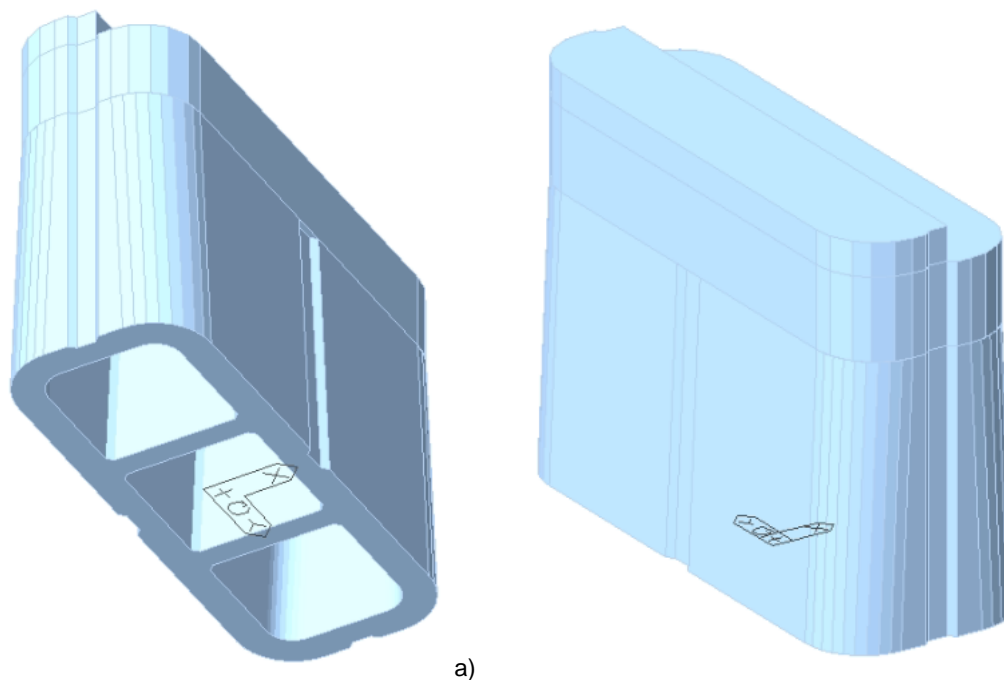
Modellazione tridimensionale agli Elementi Finiti – a) Vista 3D dal basso b) Vista 3D dall'alto – Pila P12
